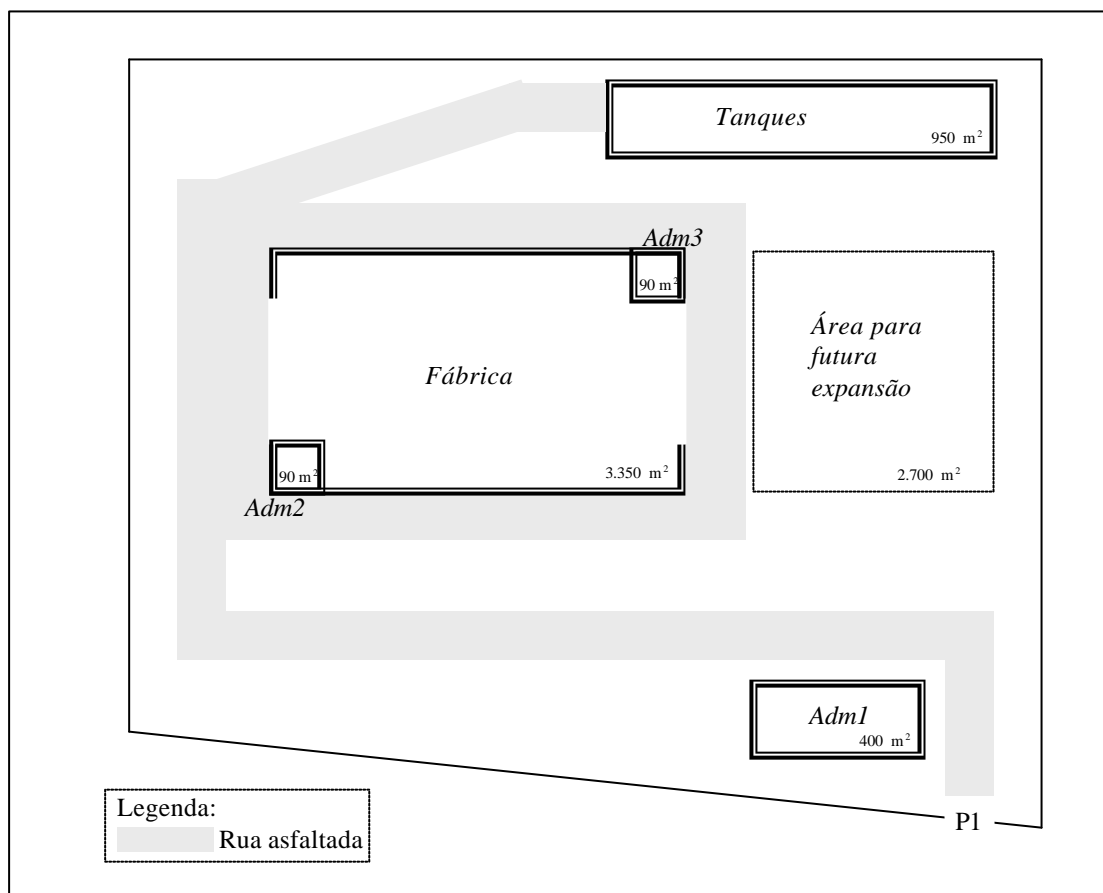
Layout geral da *planta filial*. Elaborado pelo autor.
